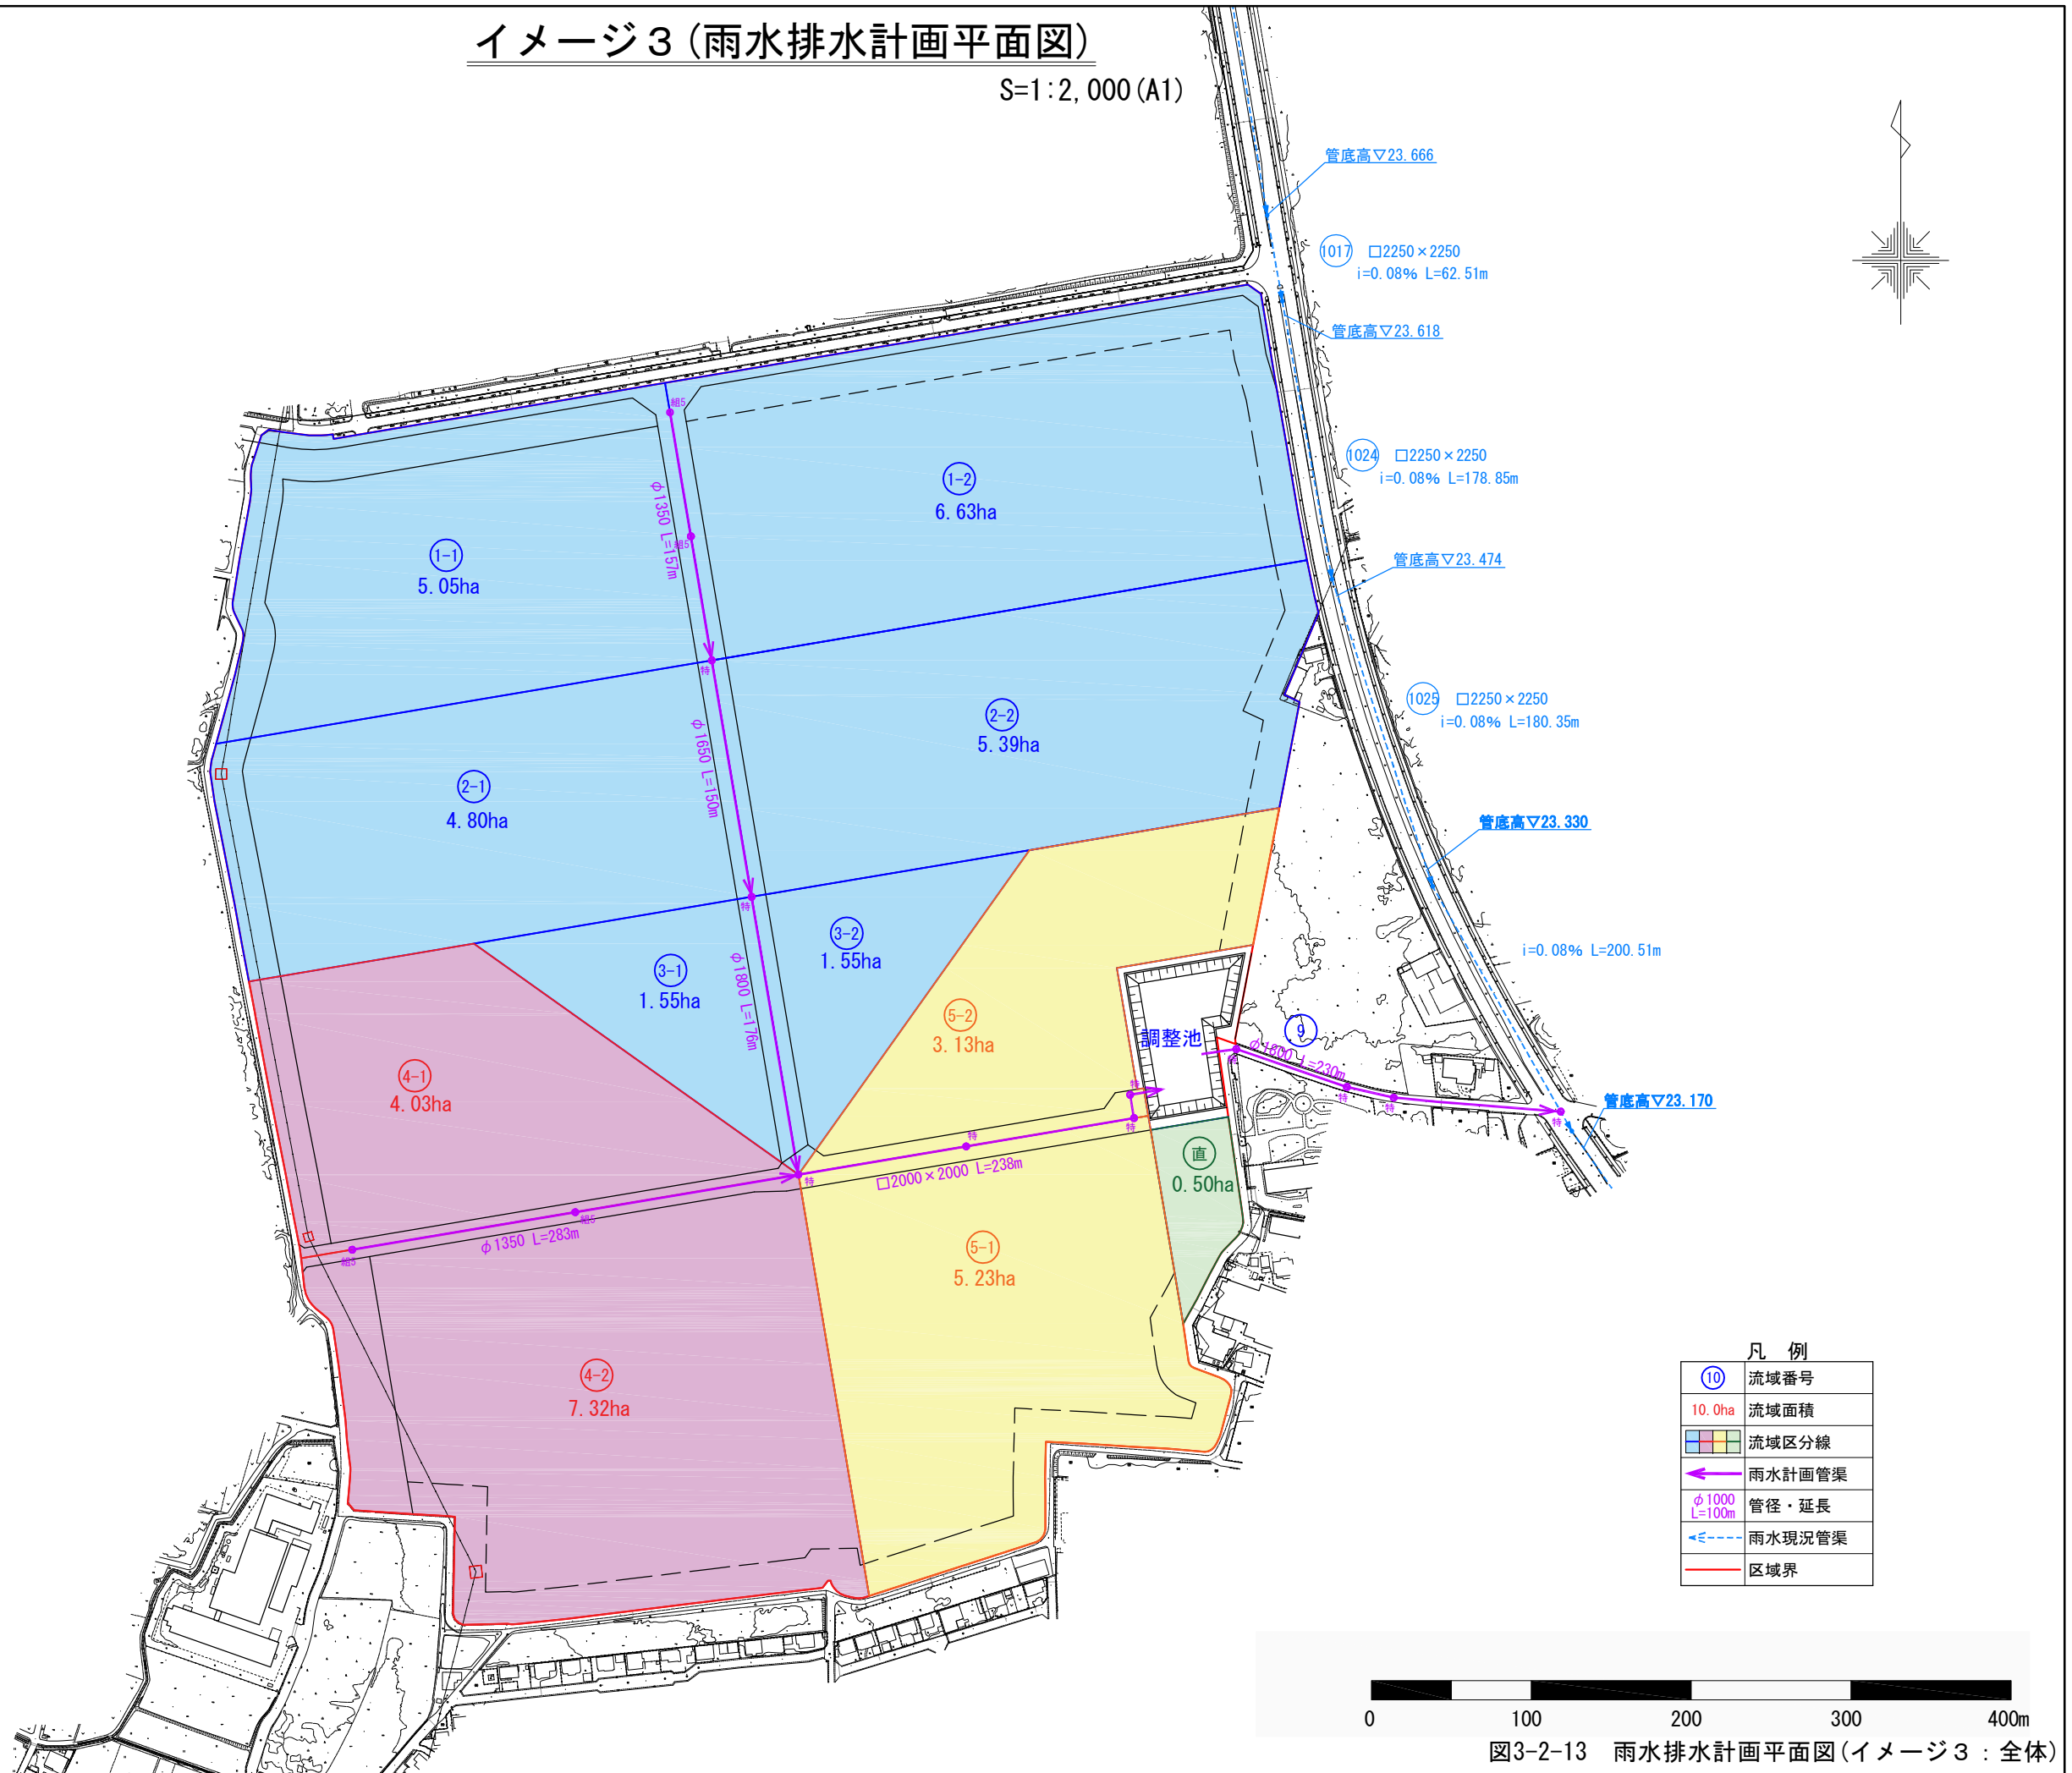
雨水排水計画平面図(イメージ3 : 全体)
